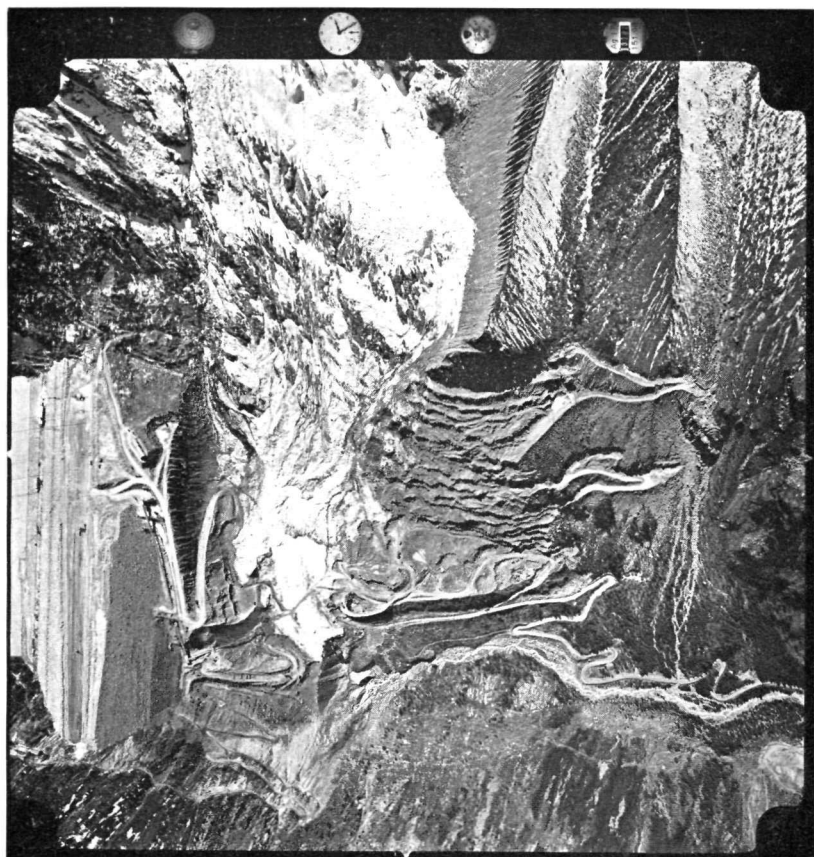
Photo du 8.9.1965. Vue de la descente de la glace sous forme de trainée blanche jusque sur l'emplacement des constructions, qui ont été recouvertes d'une épaisseur de glace de 8 à 15 m.; plus haut l'épaisseur atteignait 20 à 30 m. Le chantier des matériaux pour la construction de la digue est très visible, on a exploité une partie de la moraine nord du glacier. Les voies de transport de ces matériaux ainsi que la route de la vallée ont aussi été détruites. Sur la rive droite on distingue à peine le chemin d'Eie. Il continue vers Kreuzegge, et au-dessus de la digue. C'était le vieux chemin pour éviter le glacier quand il descendait au fond de la vallée.
